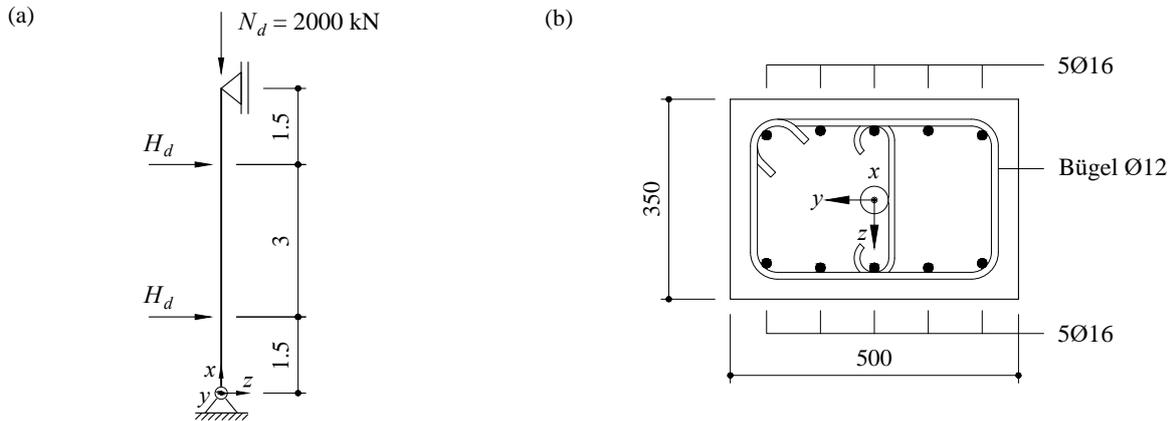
(a) Statisches System und Belastung; (b) Querschnitt mit Bewehrung (Abmessungen in mm)
